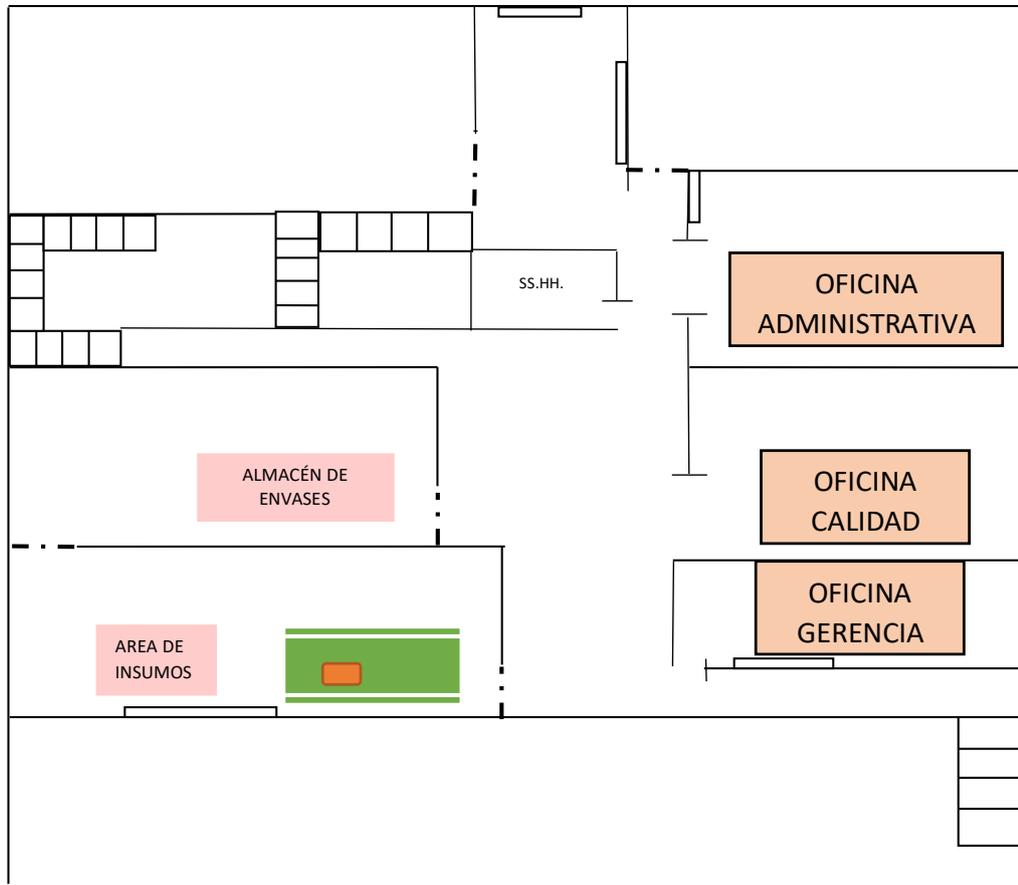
Distribución de los equipos de la empresa en la 1era planta
